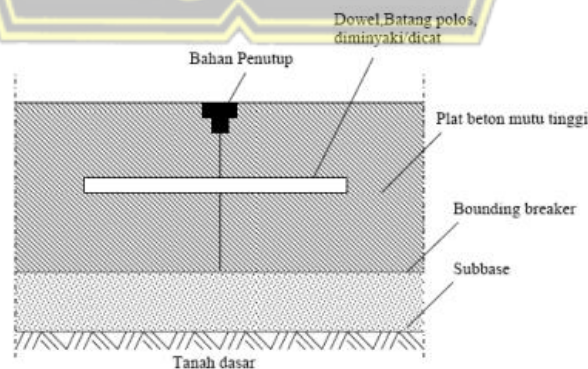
Skema Perkerasan Beton Semen Pra-Tegang
